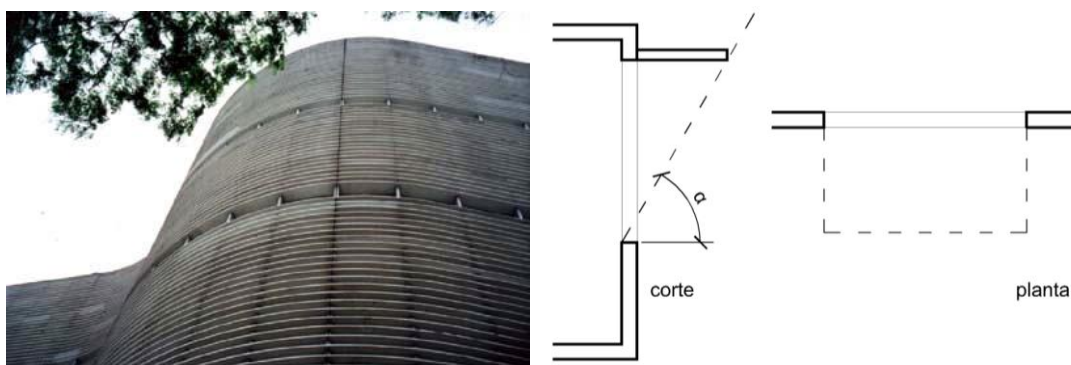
Exemplo de protetor horizontal e esquema em planta e corte.
